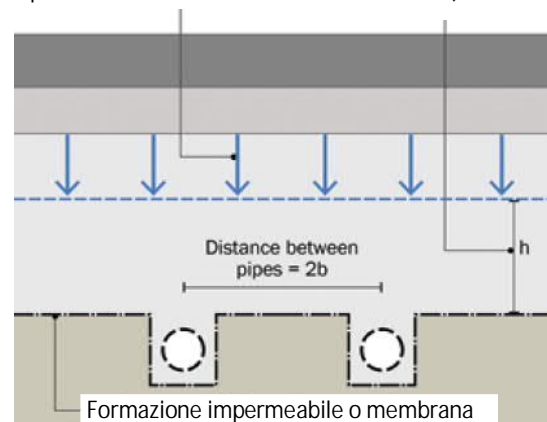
funzionamento di una pavimentazione con soluzione tipo C
